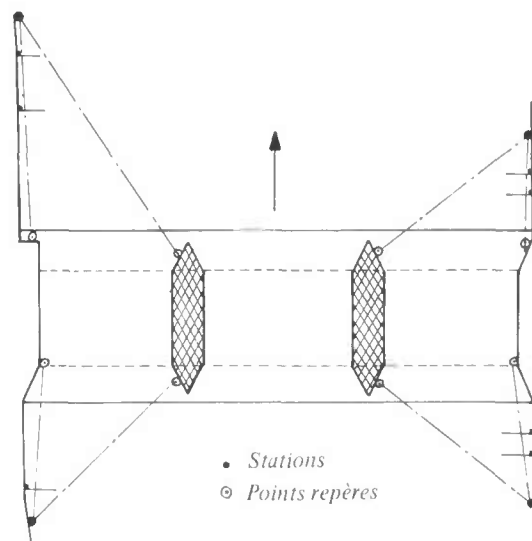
Ponte Vecchio - Dispositif de nivellement
